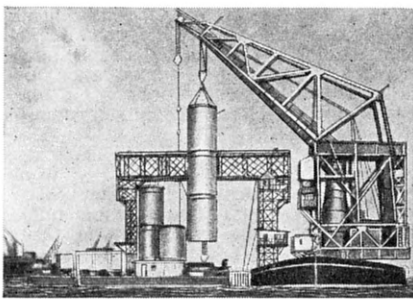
Погружение опор — железобетонных оболочек — на строительстве моста.
